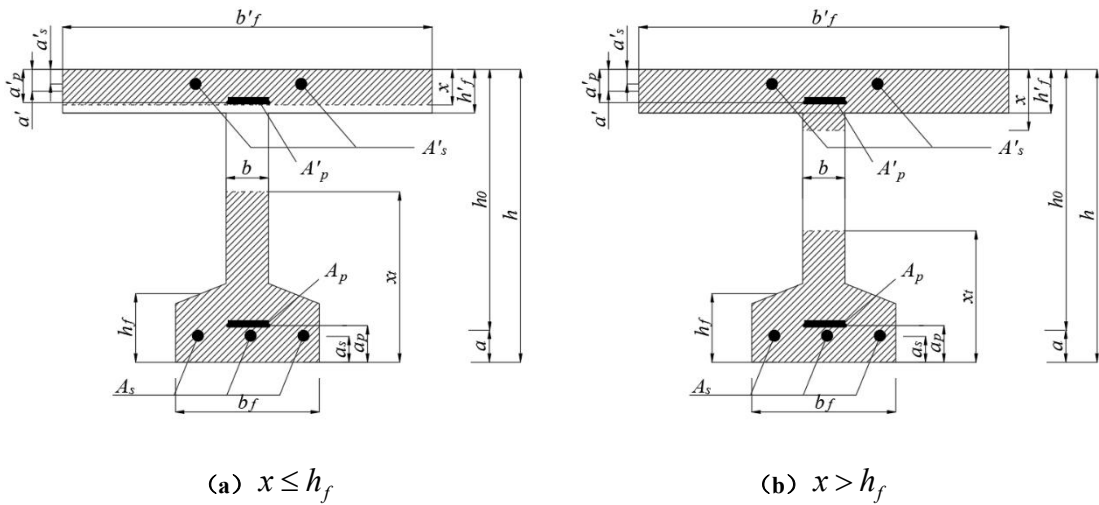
工形截面超高性能混凝土受弯构件正截面承载力计算
